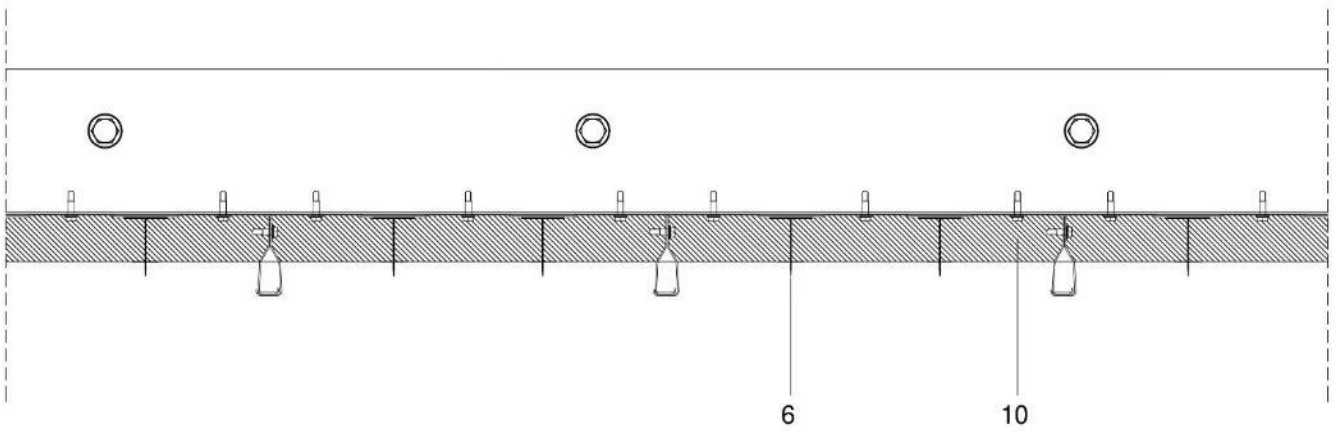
c: Sección horizontal con aislamiento térmico y fijación del aislamiento tipo 2.
